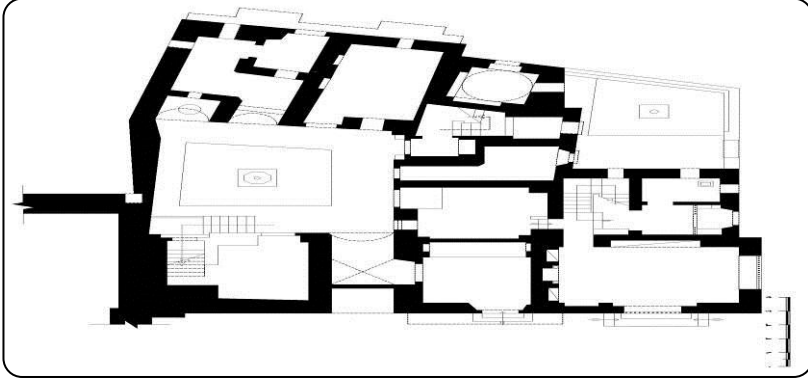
المسقط الأفقي للدور الأول للبيت العثماني موضع
